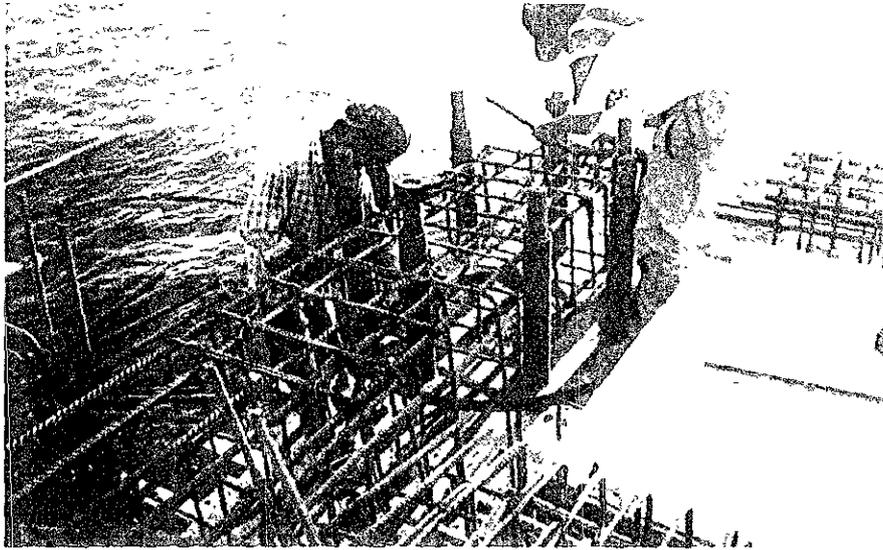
y 38. Anclaje de las anclas en el armado de la losa para la colocación de las bitas.
